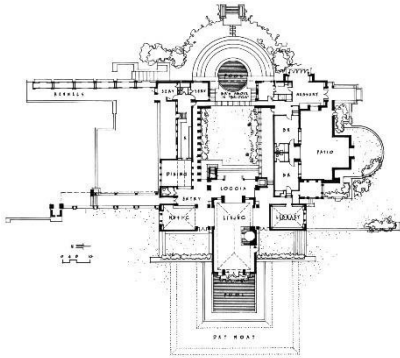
Planta de la Casa Hollyhock, Los Ángeles.
